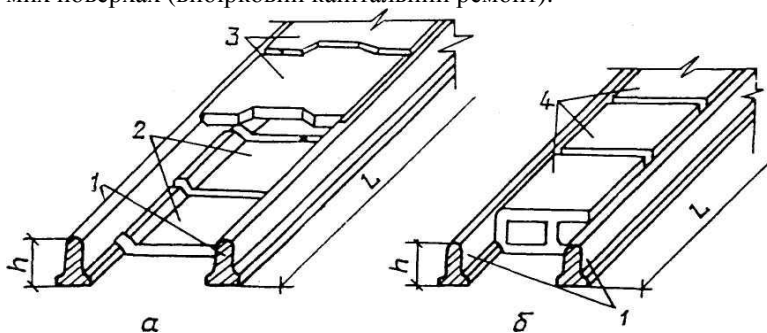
Малорозмірні збірні залізобетонні конструкції перекриттів: а – таврові балки і плити накату; б – таврові балки і порожнисті вкладиші; 1 – балки; 2 – плити накату; 3 – плити ПЗ; 4 – порожнисті вкладиші
